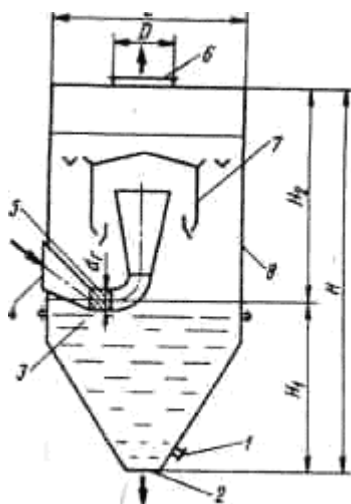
Пенно-капельный пылеуловитель РИСИ: 1 — патрубок для взмучивания шлама; 2 — отверстие для выпуска шлама; 3 — горловина дюзы; 4 — отверстие для впуска запыленного воздуха; 5 — прорези в горловине; 6 — отверстие для выхода очищенного воздуха; 7 — система капле-отбойников; 8 — корпус каплеуловителя.
